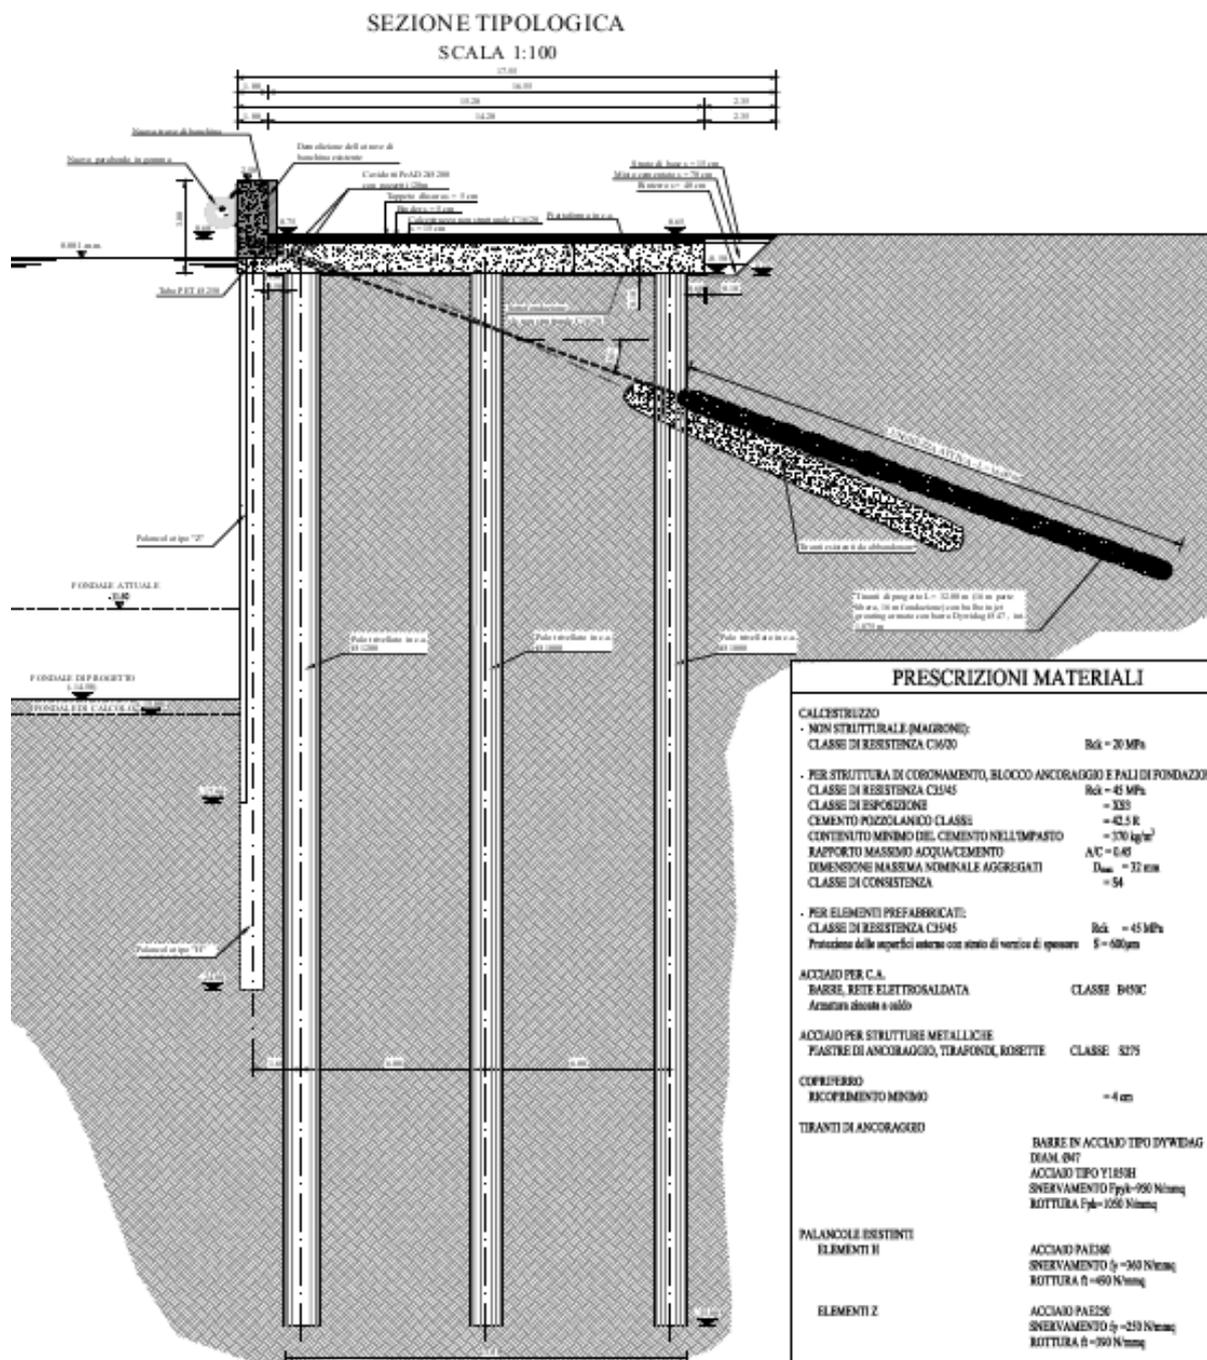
Bunge Sud – Progetto Definitivo – Sezione intervento
